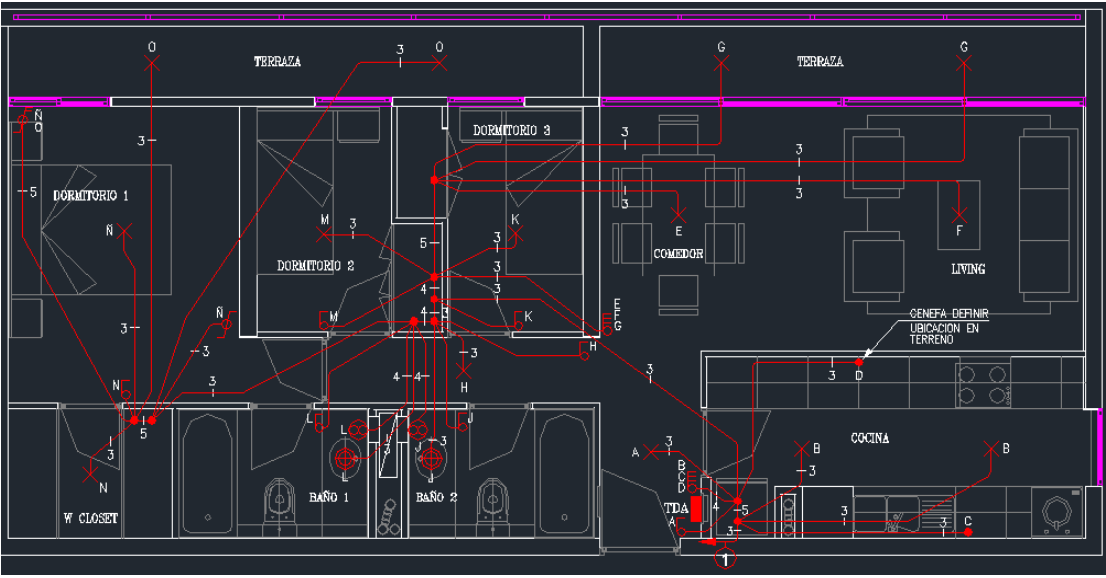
Planta distribución eléctrica luminaria (Fuente: Constructora Centauro)
